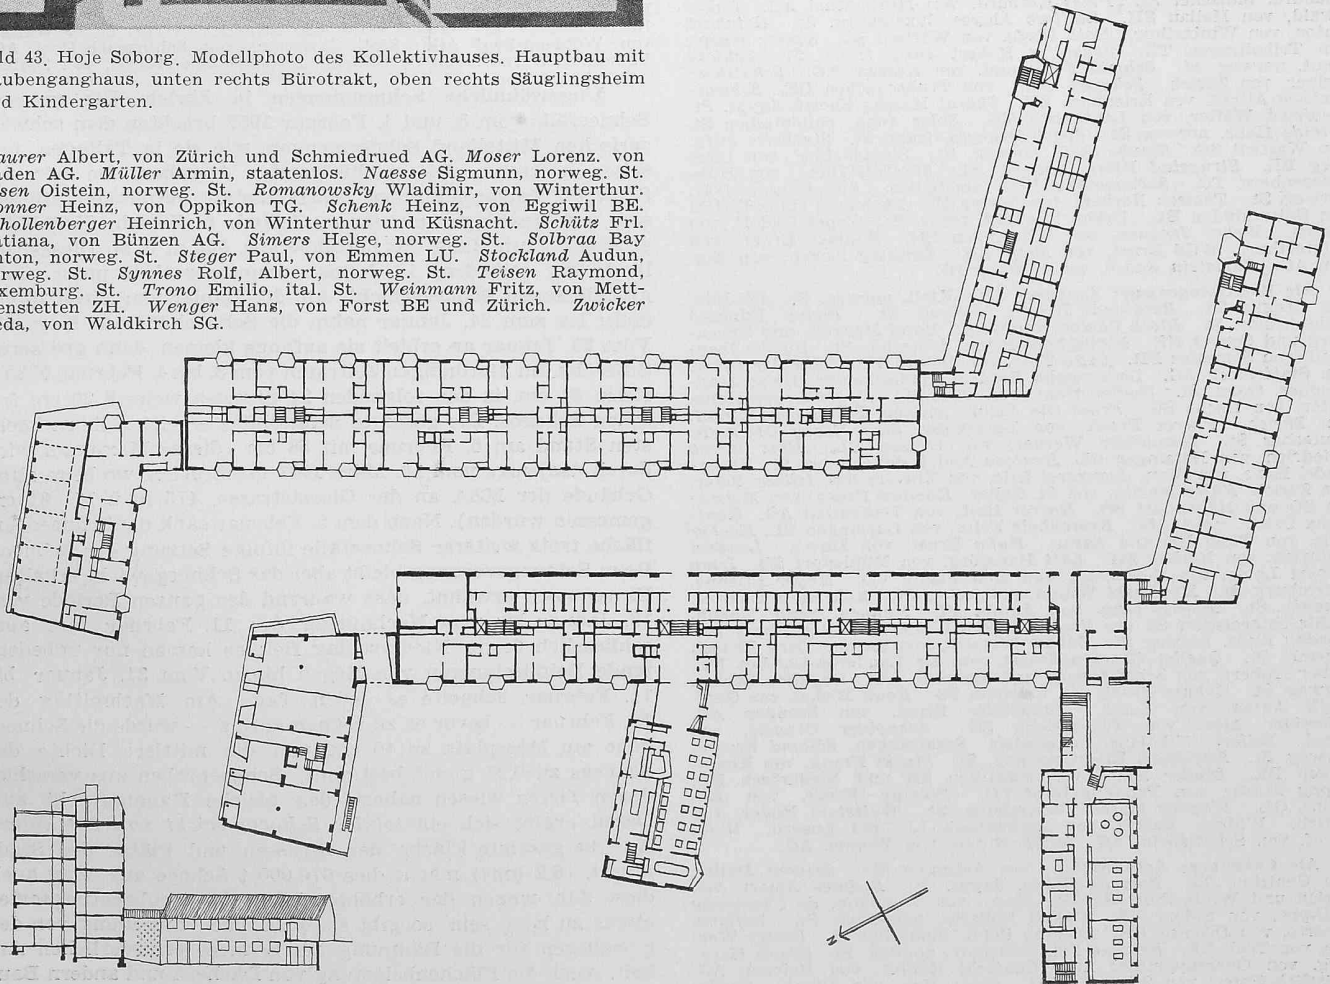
Hoje Soborg, Erdgeschossgrundriss, Normalgeschossgrundriss und Schnitt, 1:1200
